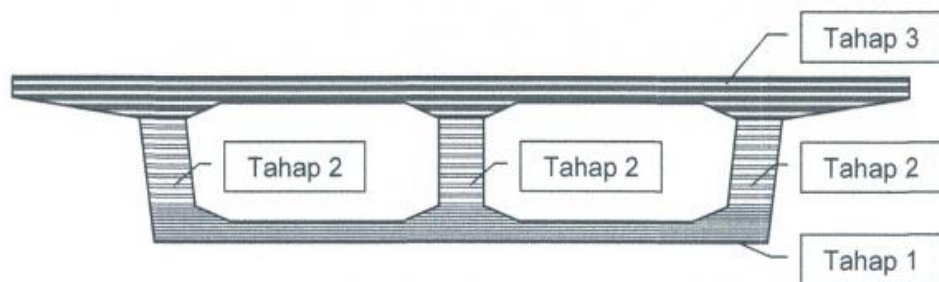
31 Layout Box Girder Ramp 7 (D2)
